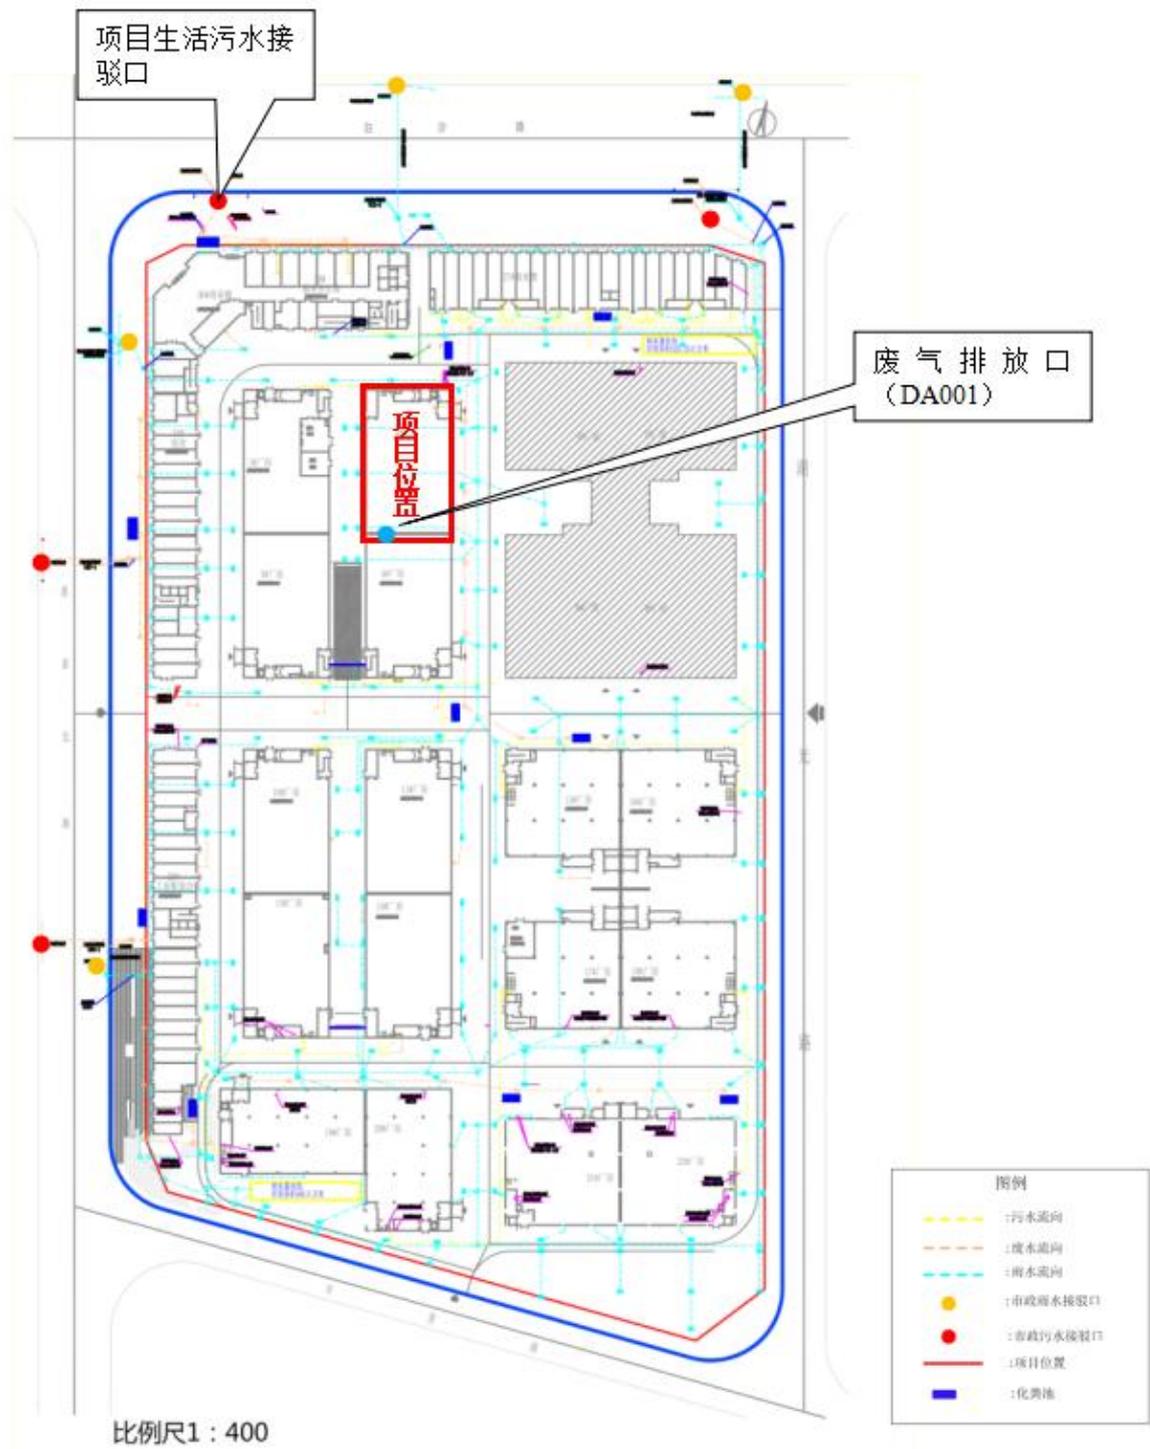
平面布置图（厂区总平面布置及雨污分流）
